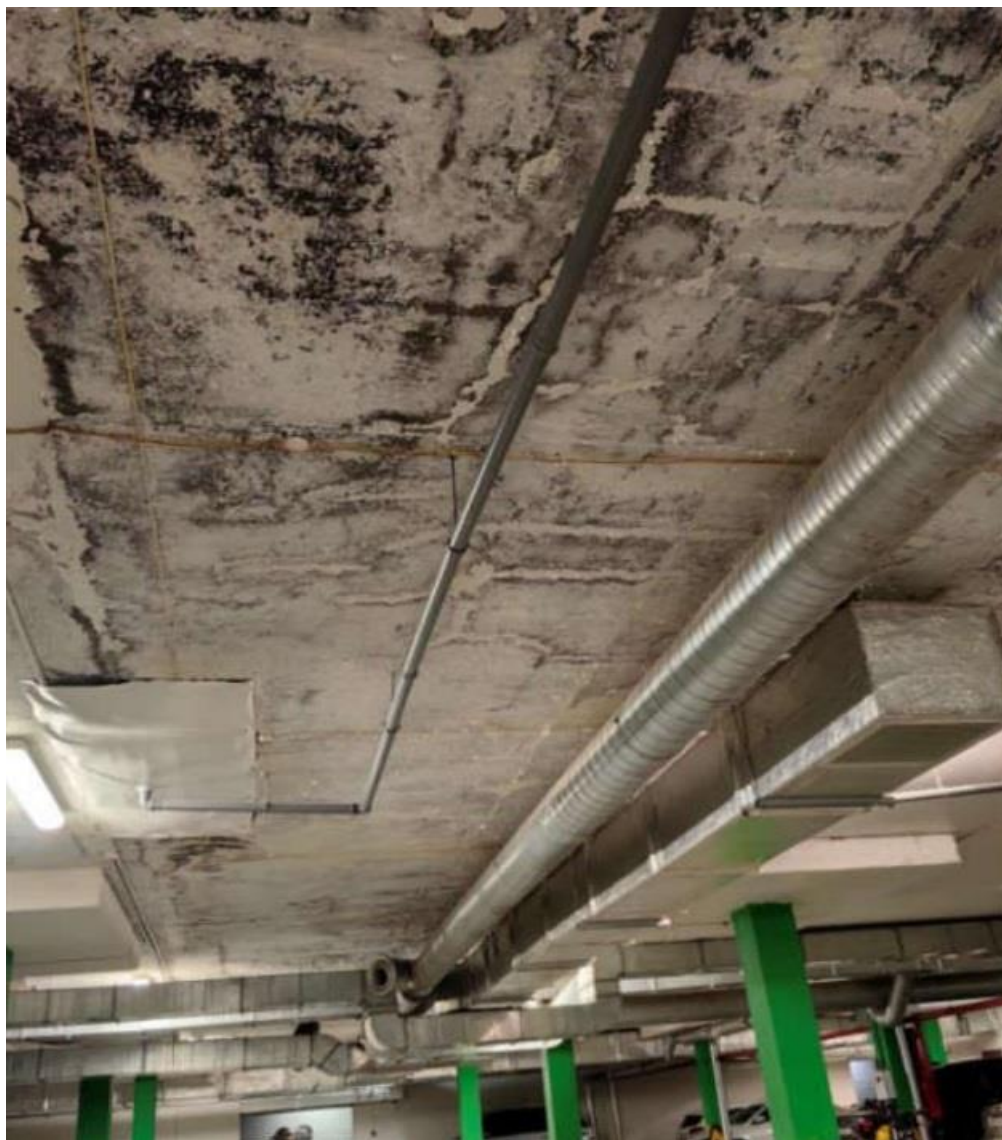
II этап строительства, оси 8-9/Б-Ж. Следы систематических протечек по плите покрытия. Трещины в плите покрытия.
